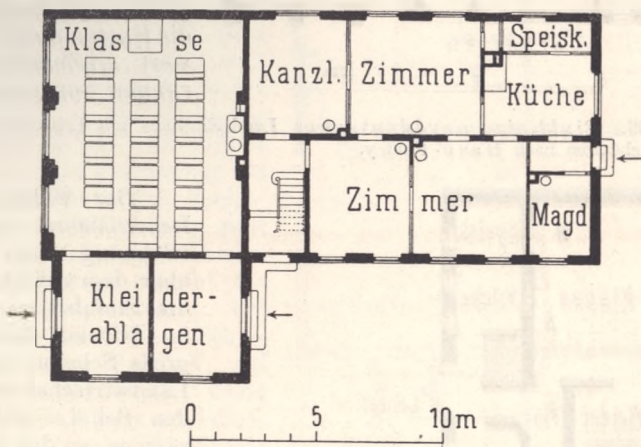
Einklassiges dänisches Landschulhaus mit Lehrerwohnung. Nach den ministeriellen Projekten.
